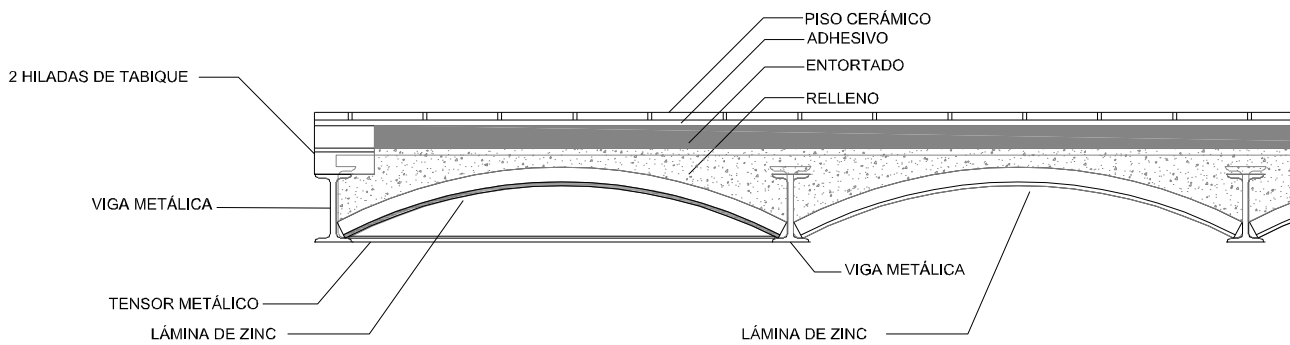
Detalle constructivo de bóveda de lámina de zinc.
